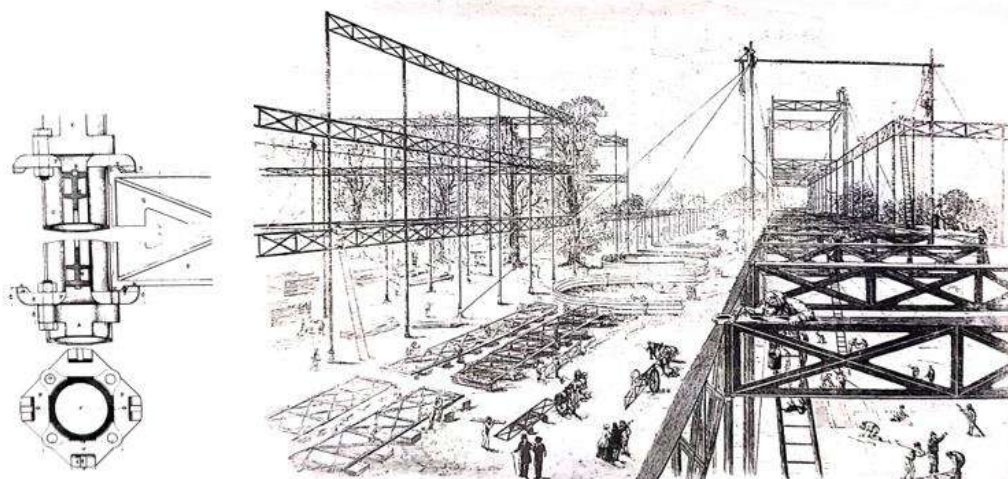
Palácio de Cristal. Detalhe de ligação de componentes metálicos e ilustração da construção.
